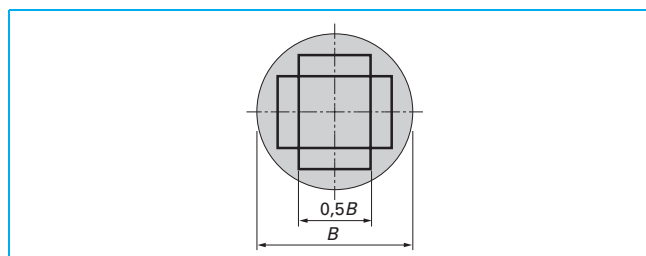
Armatures orthogonales d'une semelle circulaire (figure 9.12 de l'EC2)
